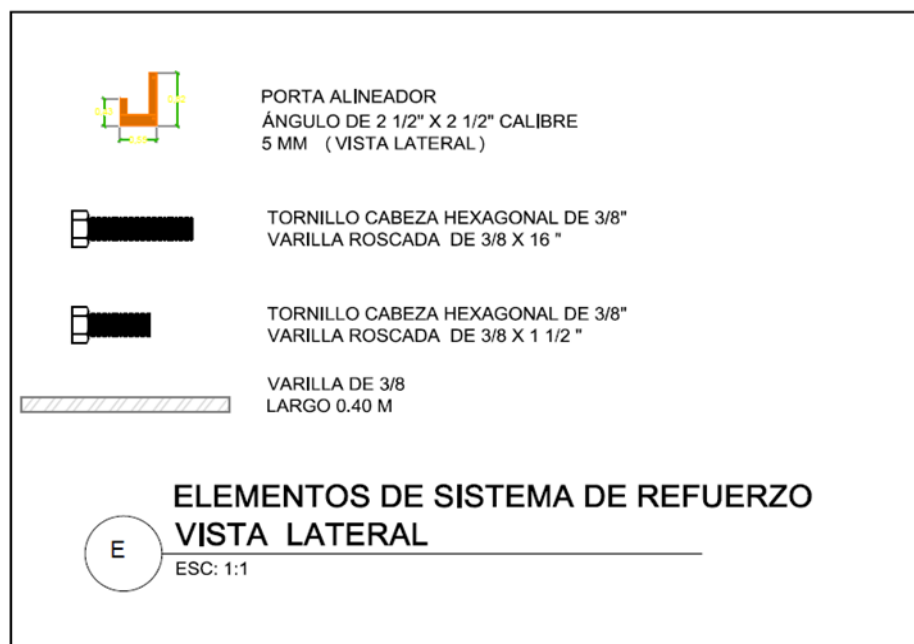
Sistema de refuerzo de muro (Paral plomador de muro)
